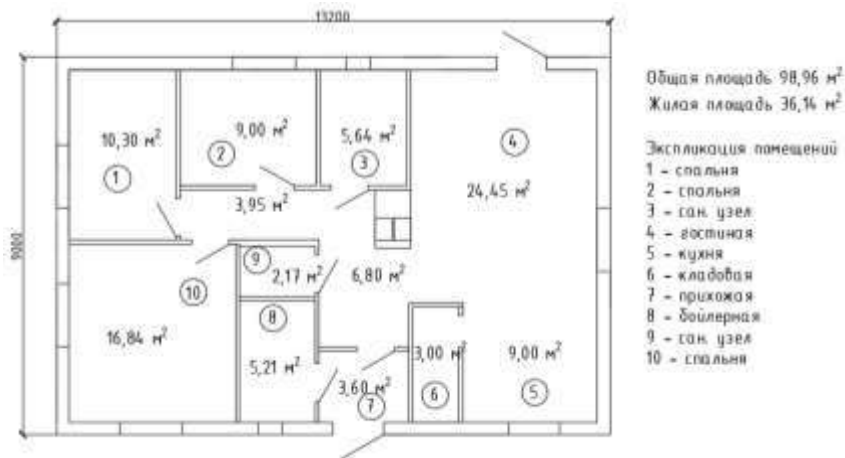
План одноэтажного дома со стенами из газобетонных блоков
